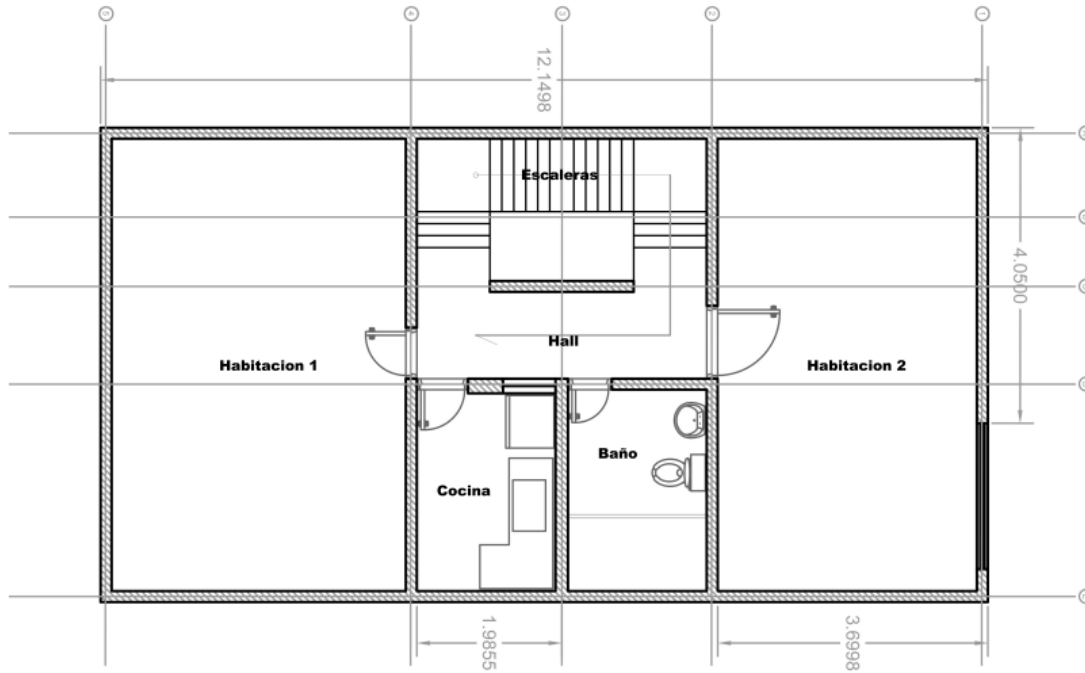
Proyecto vivienda popular, planta arquitectónica segundo nivel. Levantamiento 2015.
